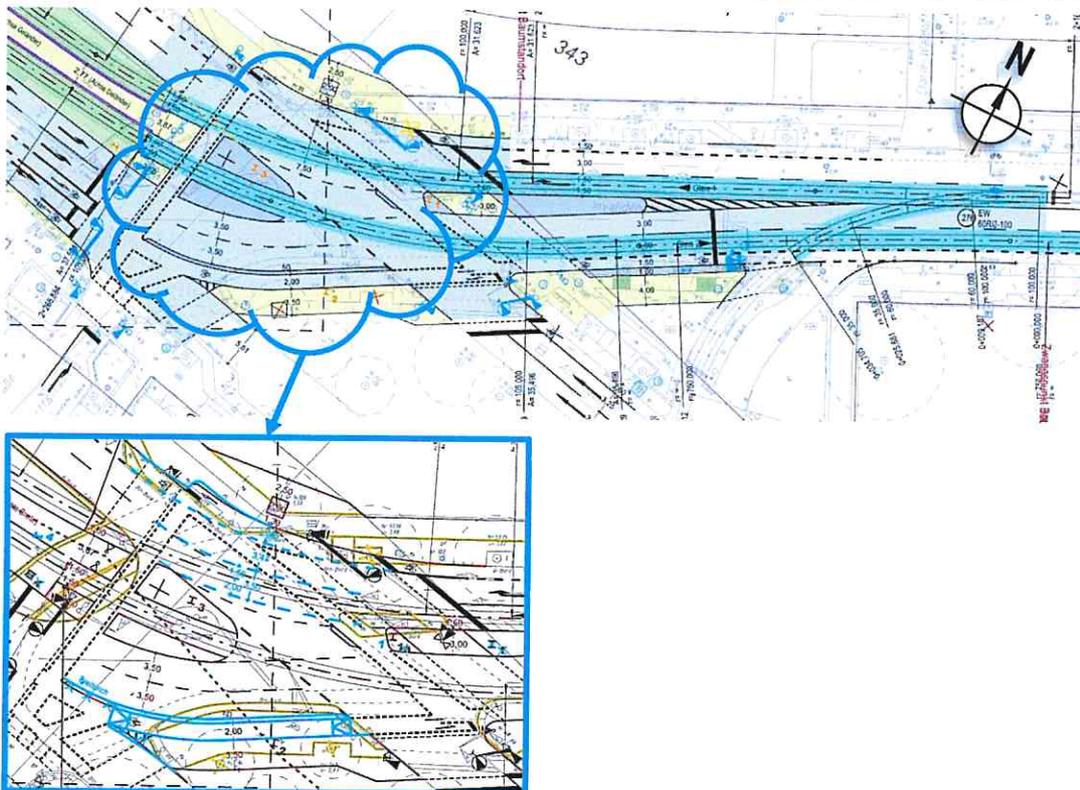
Lageplan Knoten Invalidenstraße/Alt-Moabit mit Änderung Markierung und Radverkehrsführung
